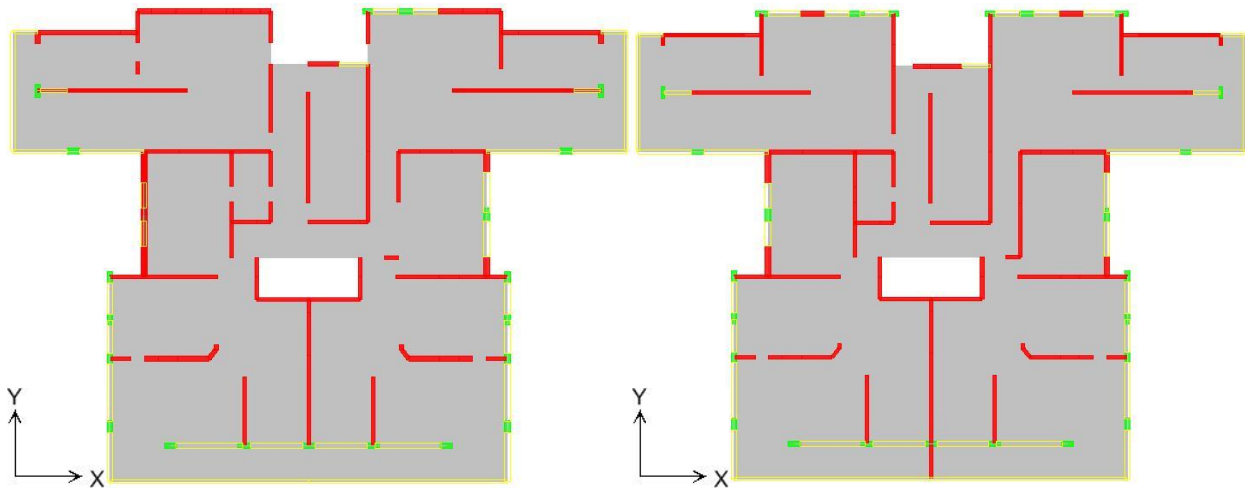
Planta primer piso (izquierda) y piso tipo (derecha) edificio H11
